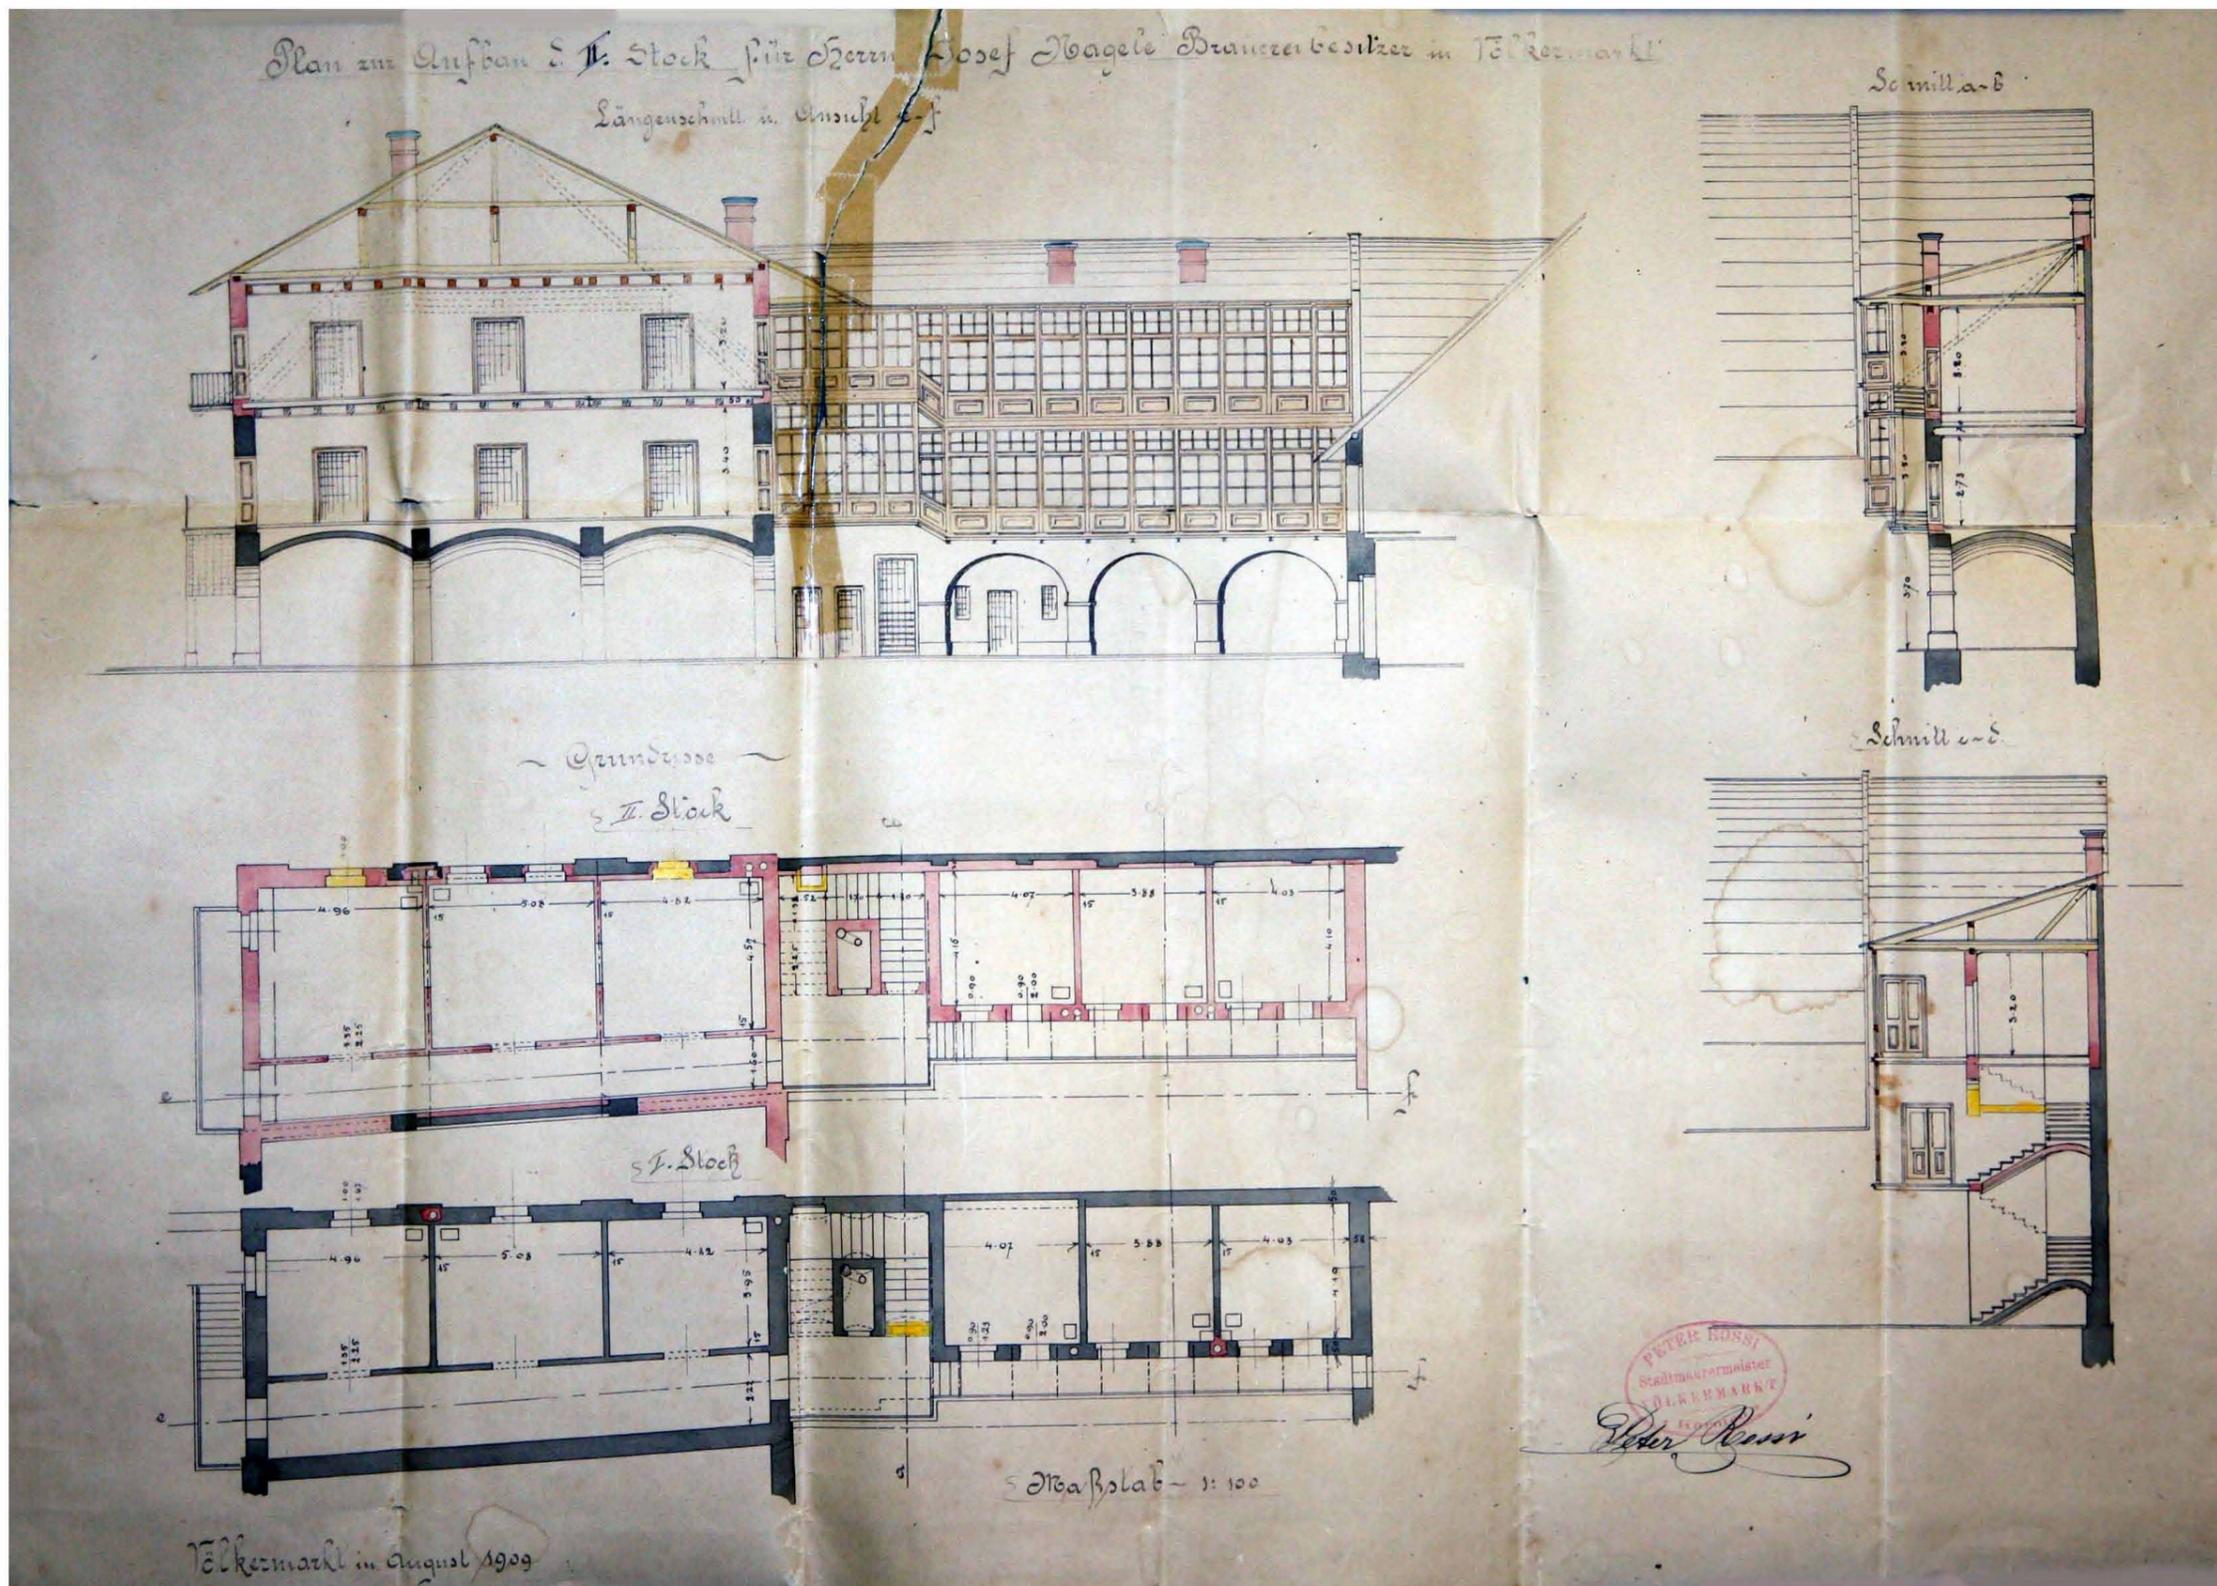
Aufstockung Nordtrakt 1909 Südansicht, Grundriss vom 1. und 2. Obergeschoss, Schnitte
